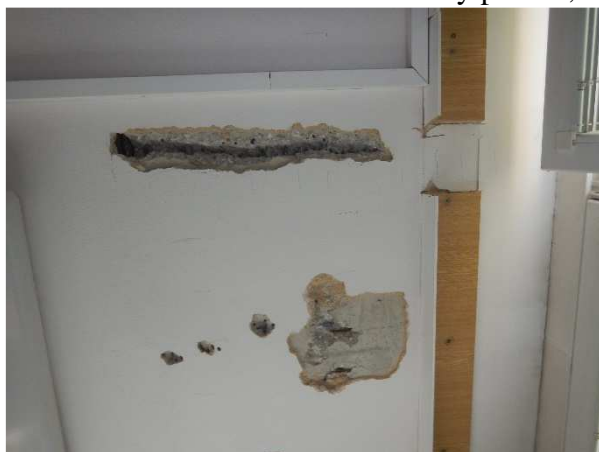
a 10 – sonda NV 4 – celkový pohled, detail výztuže
